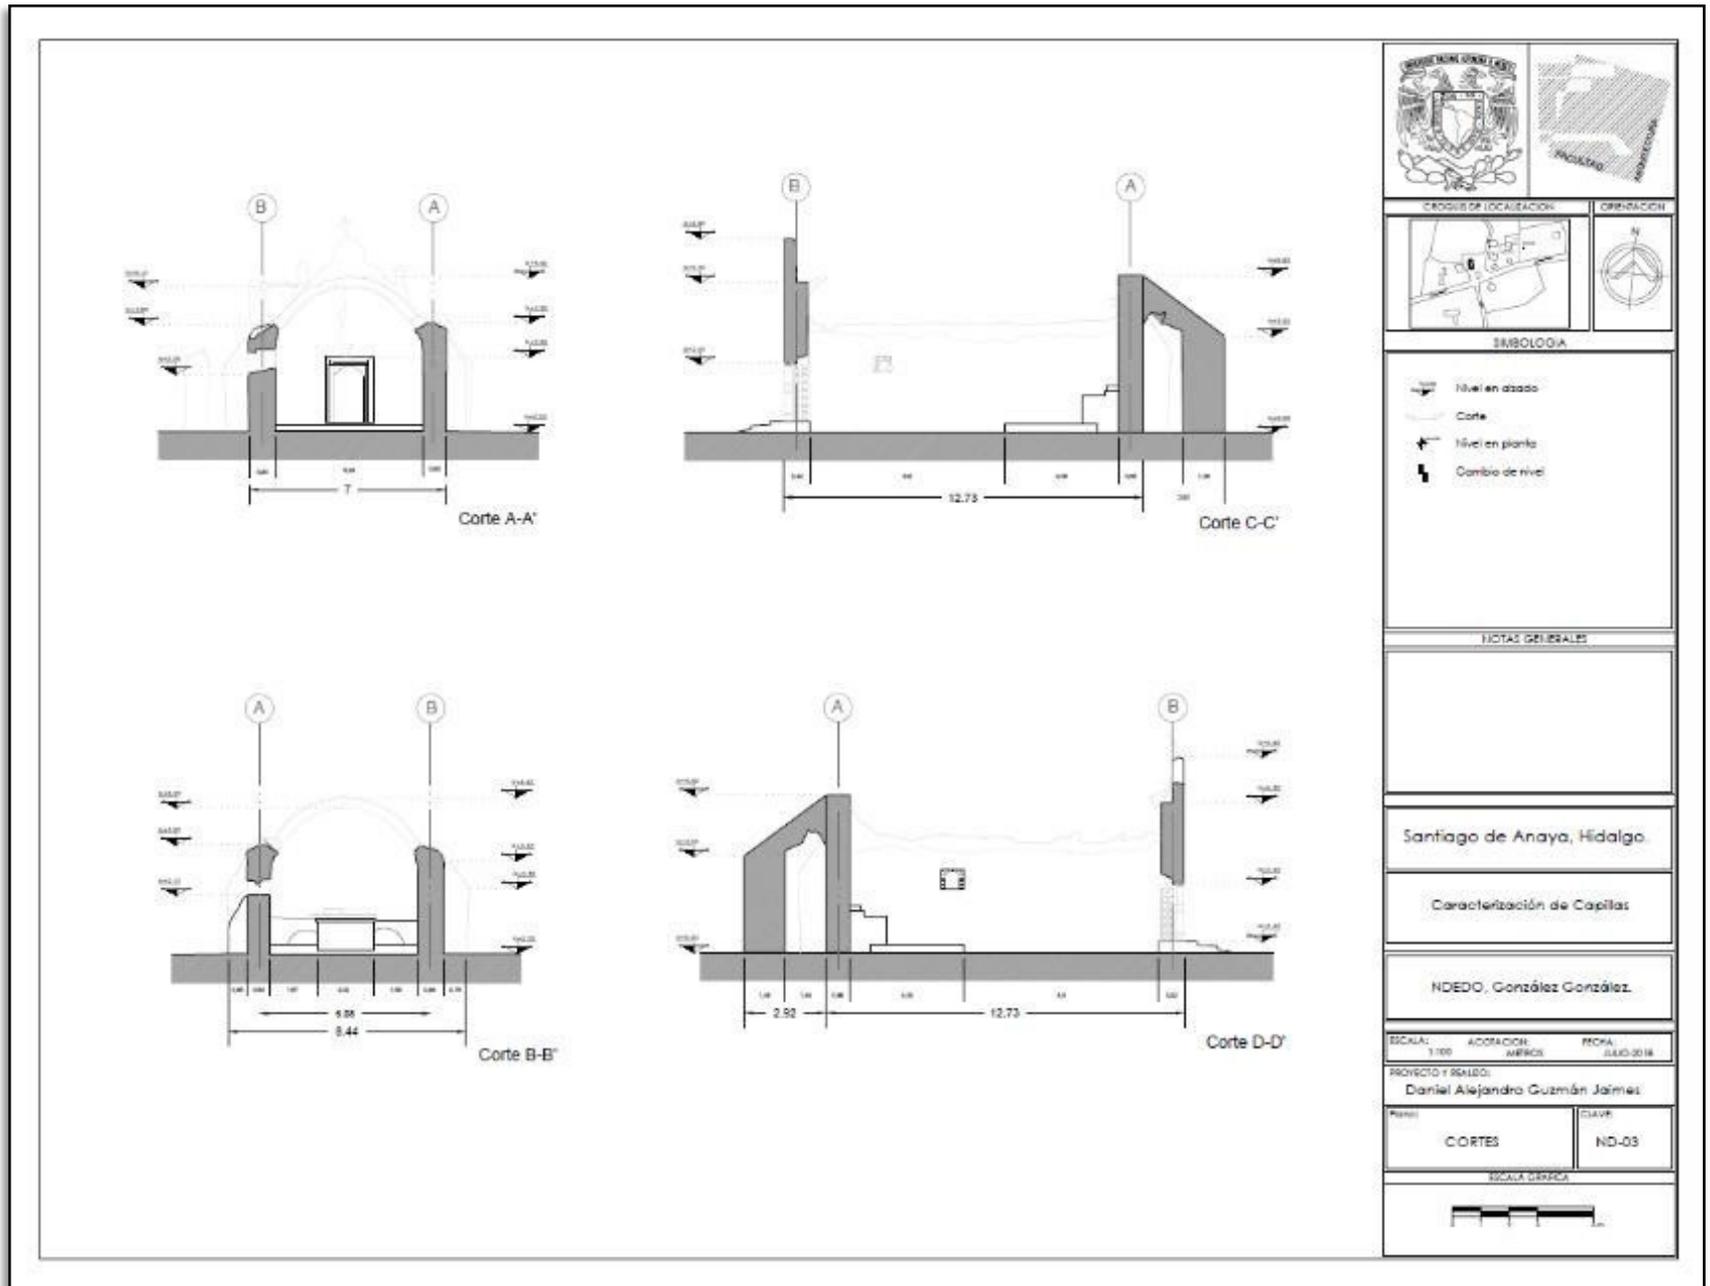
Vista final del plano arquitectónico de cortes, capilla de Ndedo.
